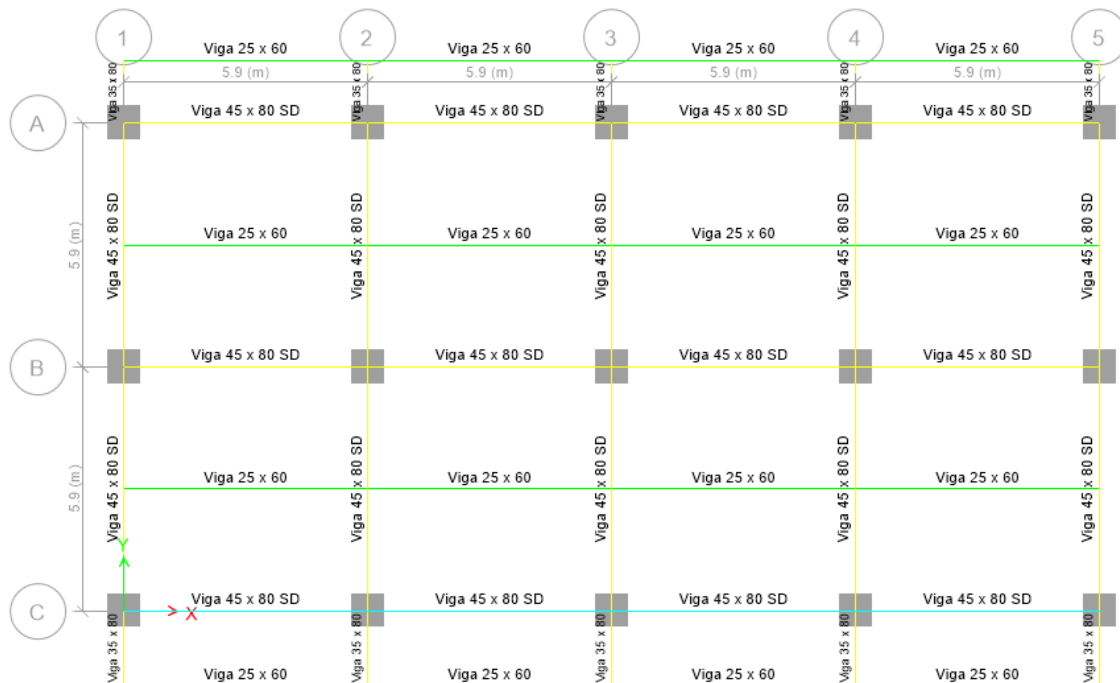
Elementos Estructurales en Entrepiso 1. (Nivel 2)
